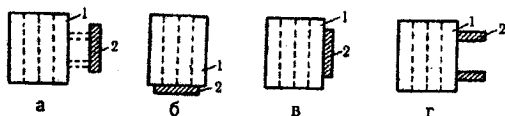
Схеми розміщення будівель з адміністративними та побутовими приміщеннями: а – із спеціальними тепловими переходами, б – межування з поперечною стороною виробничої будівлі, в – межування з поздовжньою стороною виробничої будівлі, г – прилягання торцевою стороною; 1 – виробнича будівля, 2 – бідвлі з адміністративними та побутовими приміщеннями
